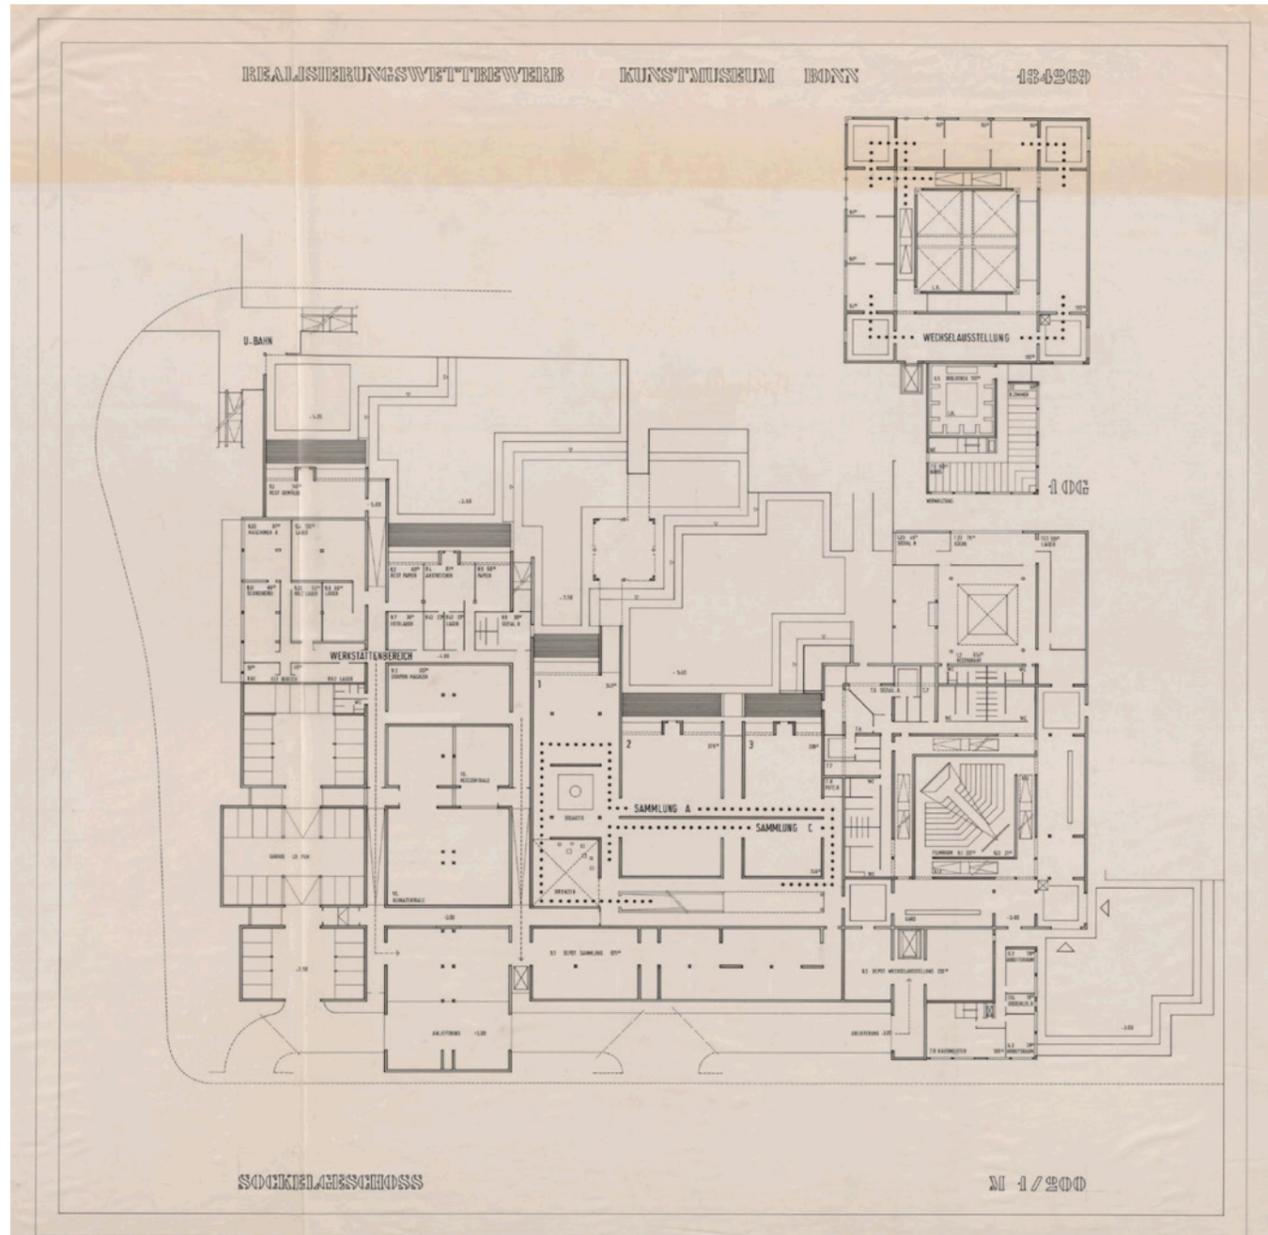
Sockelgeschoss und 1. Obergeschoss (Grundriss), 1985
